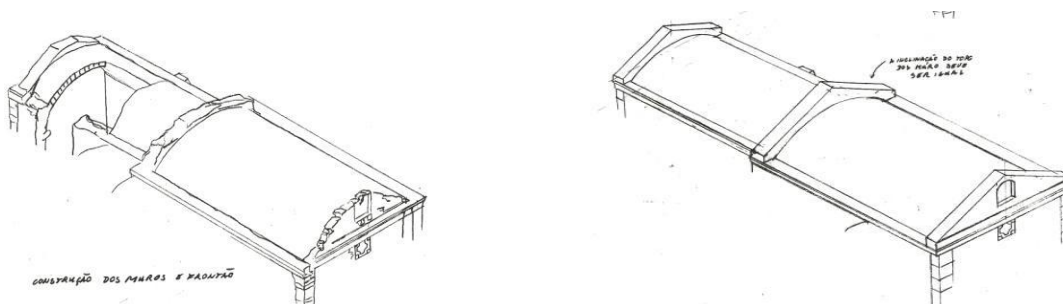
Desenhos da evolução da reconstrução da abóbada e paredes de apoio das vigas do telhado.
